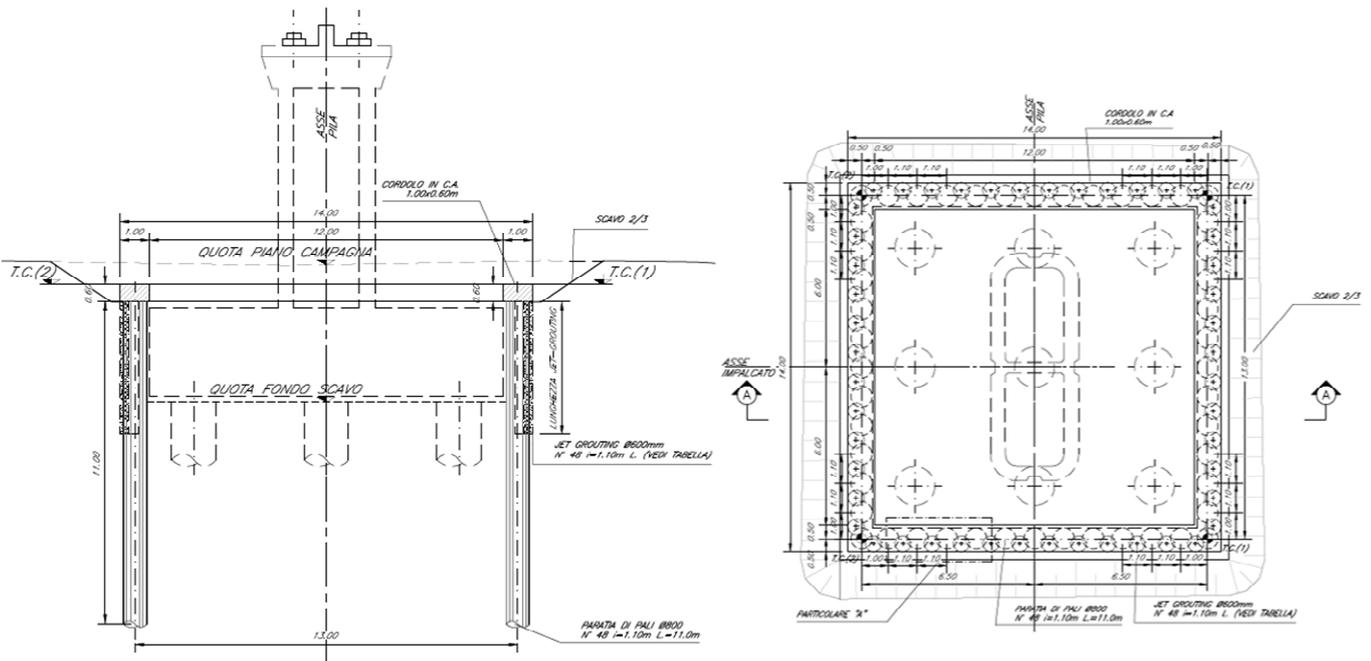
Geometra di riferimento pila P3-P7-P22
